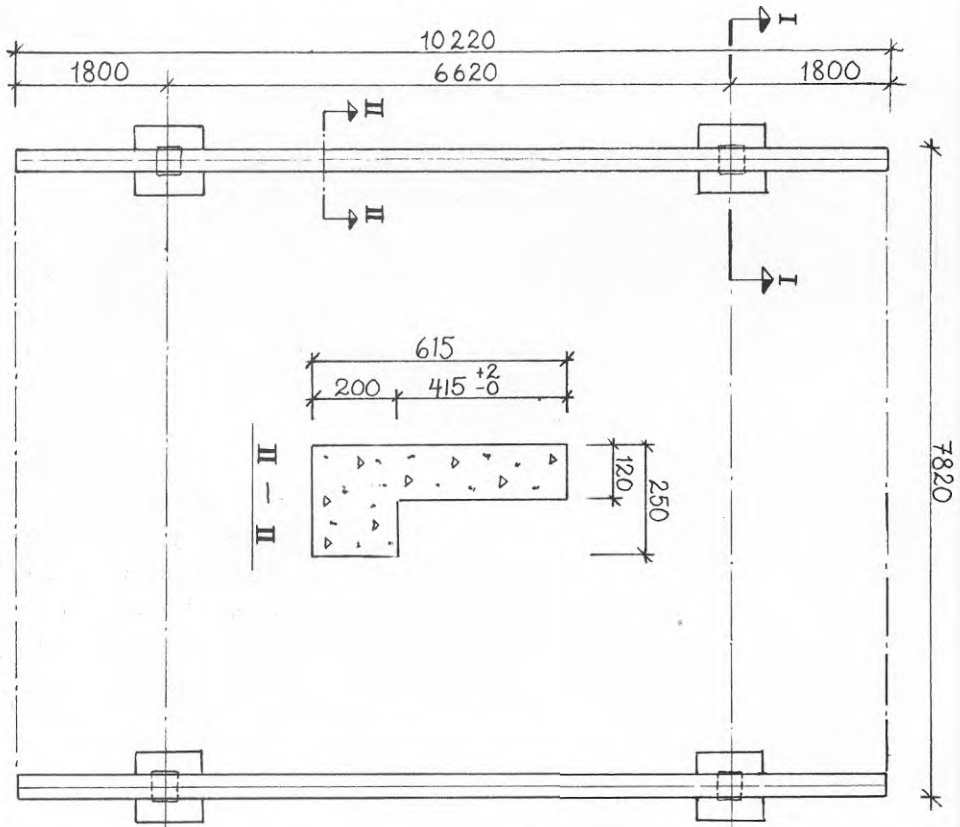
B Grundplan med infälld sektion av grundbalk.
